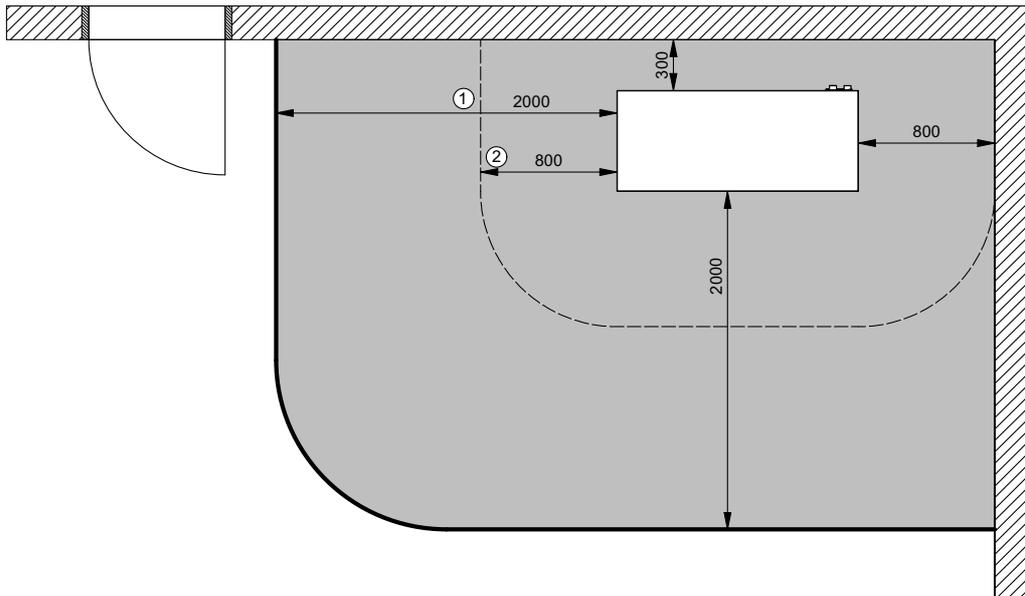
Zona sicura (installazione a livello del pavimento) in caso di installazione ad angolo
